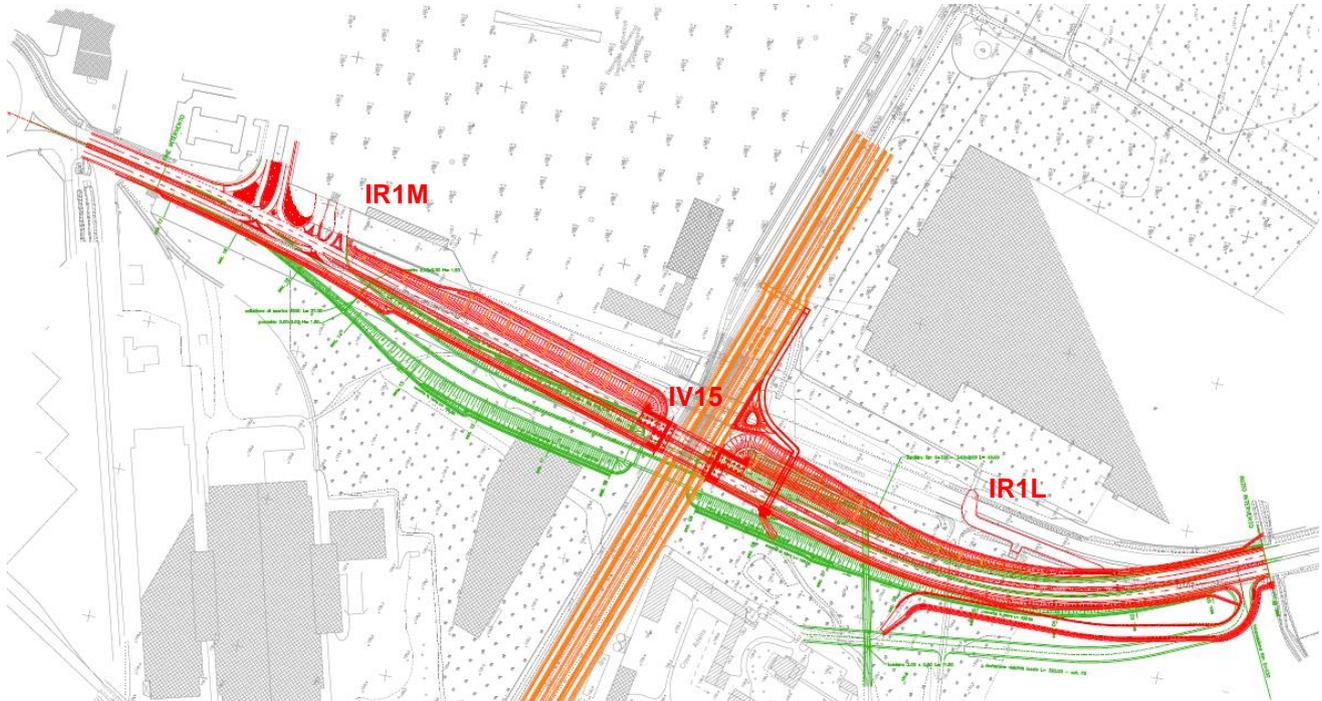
Sovrapposizione progetto definitivo (in colore verde) e il progetto della nuova configurazione planimetrica (in colore rosso)
